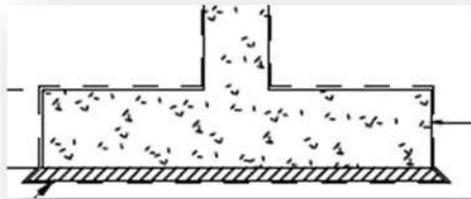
Alternativa de zapata con pie hacia afuera y al interior de la estructura.
